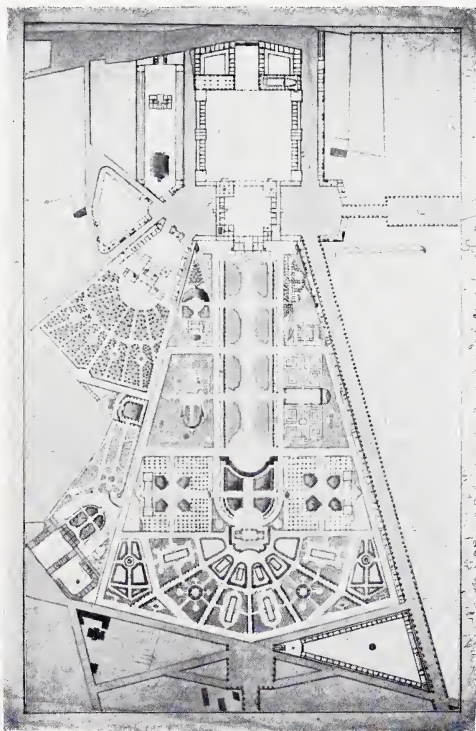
Grundriß des Sächsischen und des Brühlschen Garten nebst den beiden Palaisgrundrissen im 18. Jahrh.
